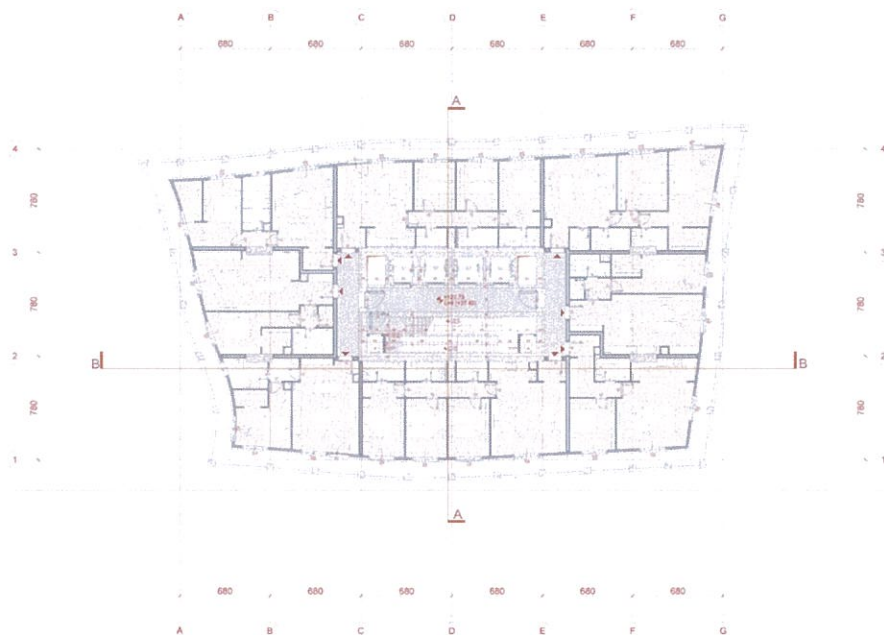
Planimetri e katit +9, në kuotën +37.40 (Tipologji e banimit 3)
